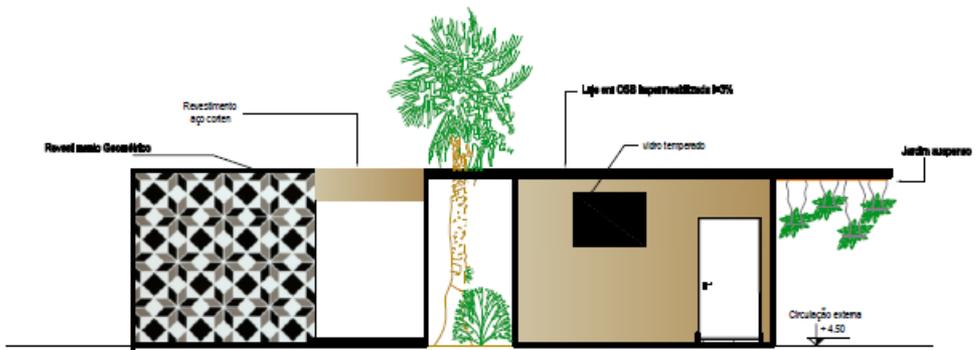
Vista bloco de banheiros e apoio/ Fonte: A autora, 2017.
